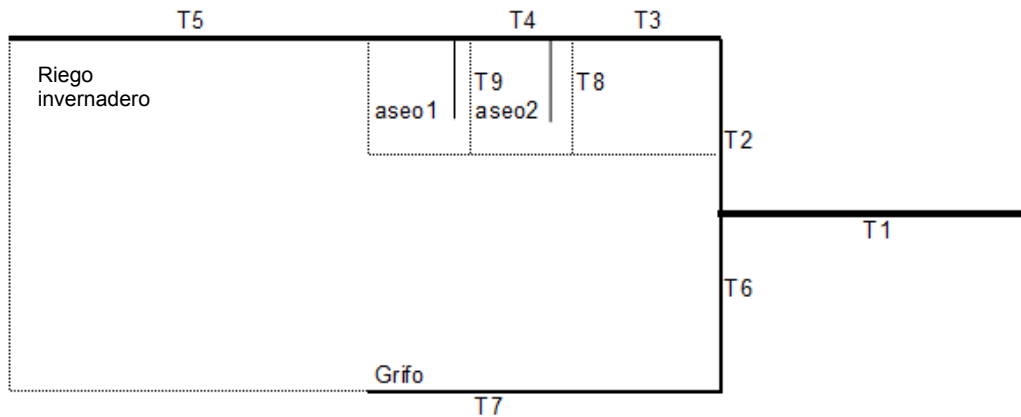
Tramos de tubería para el cálculo de las pérdidas de carga
